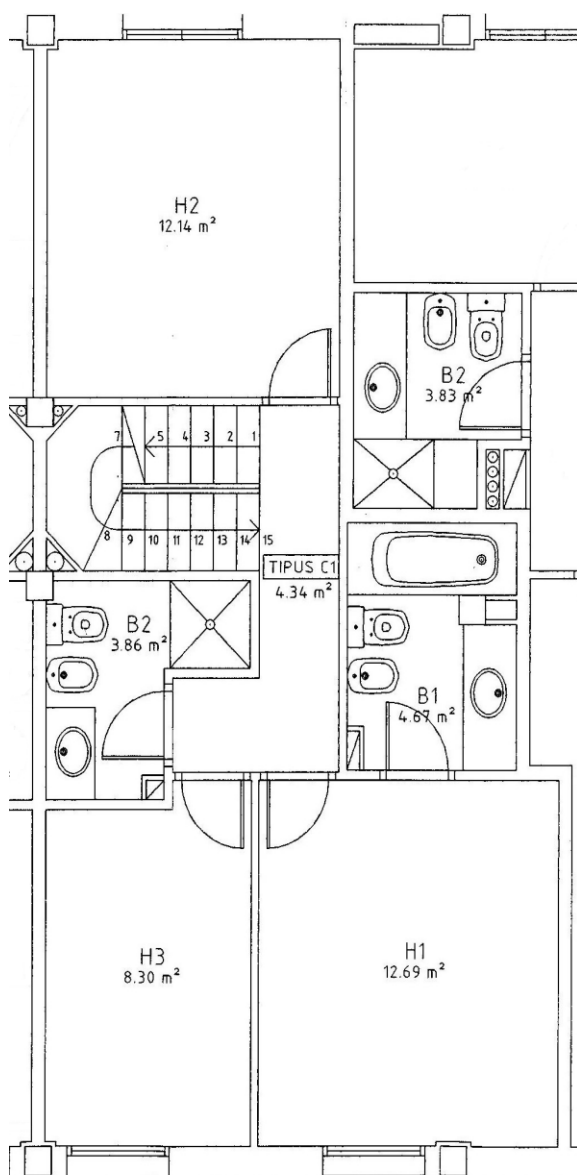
Plano de la primera planta (memoria de calidades de la vivienda).
